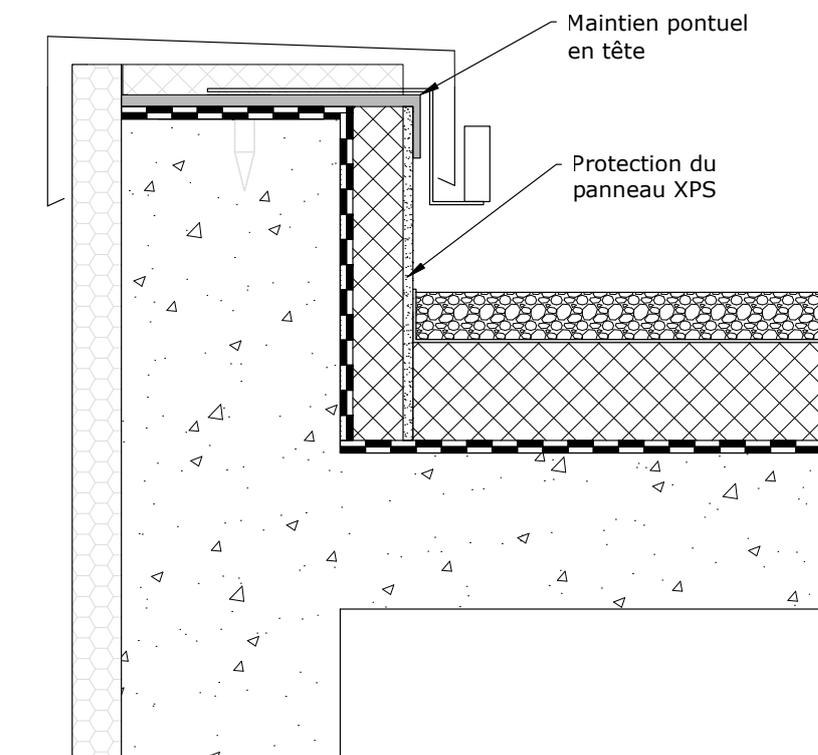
Toiture-terrasse inaccessible ou technique - Exemple
